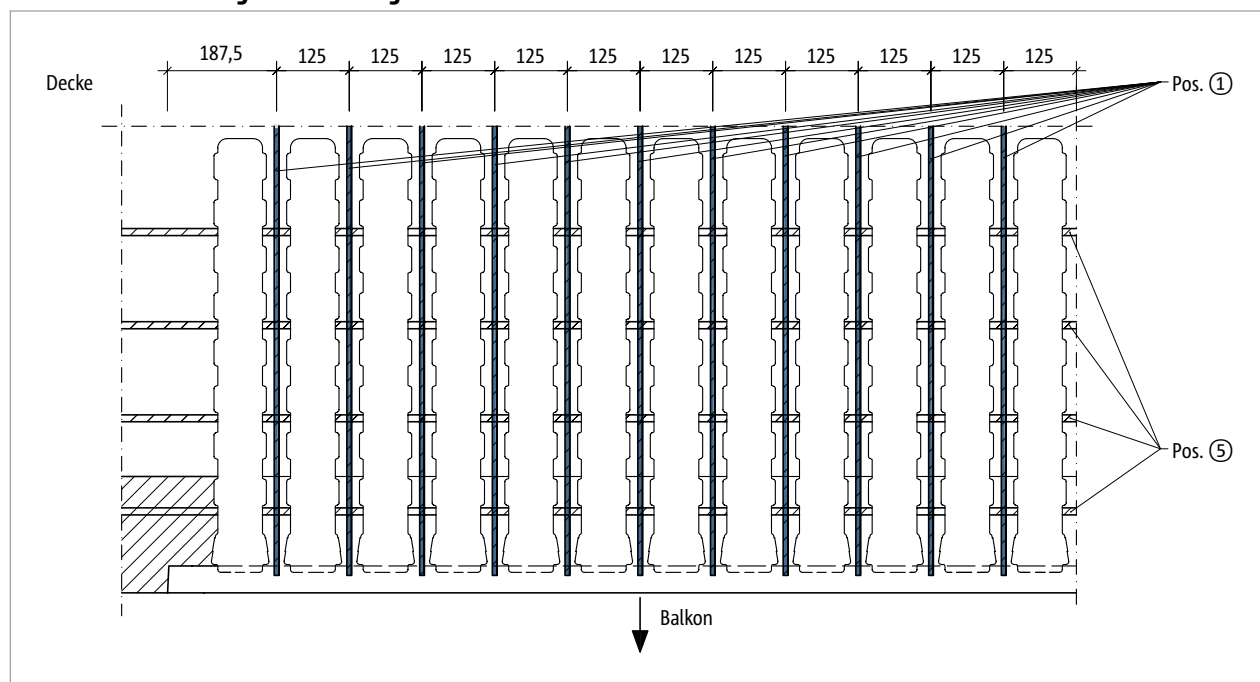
Schöck IDock®: Achsmaß der bauseitigen Bewehrung im Grundriss
